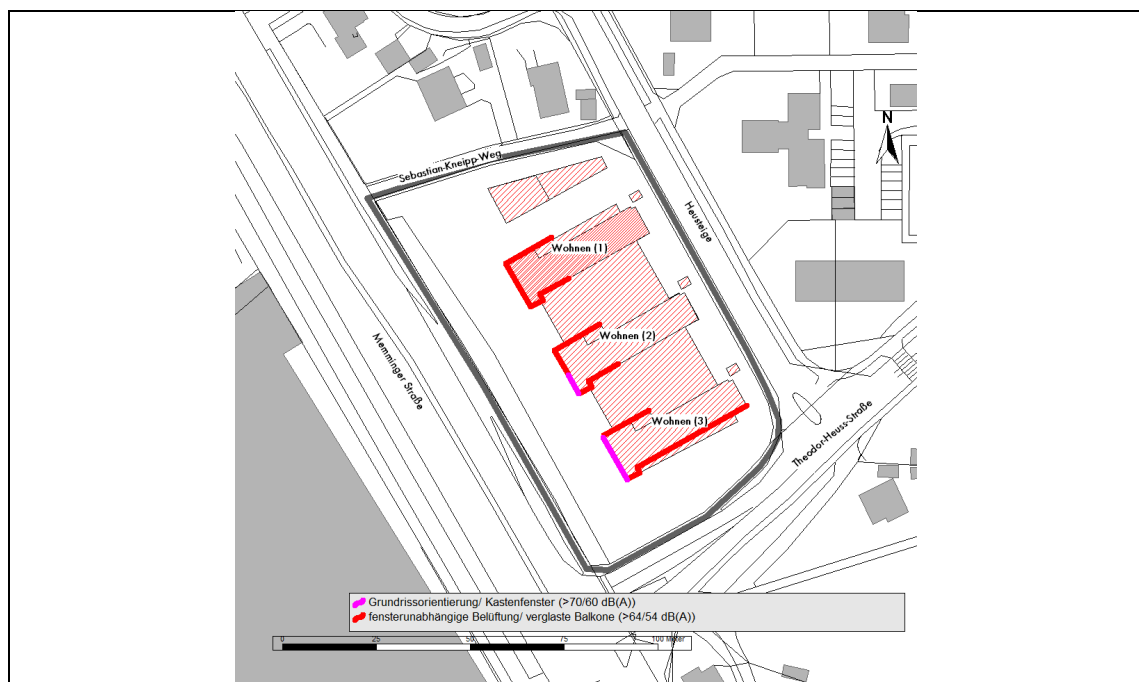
Restriktionsplan der Planbebauung mit Grundrissorientierung/Kastenfenster und fensterunabhängiger Belüftung/verglaste Balkone
